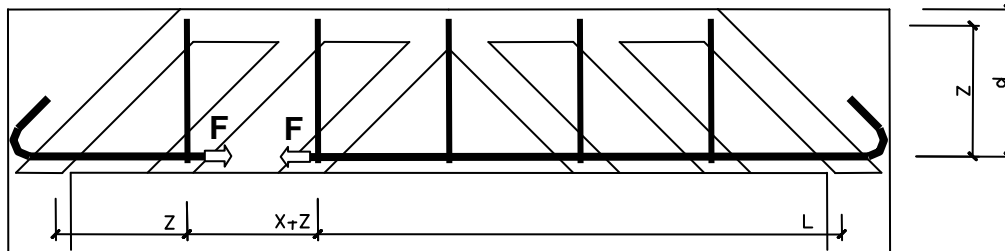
Traction dans les aciers longitudinaux de la poutre
